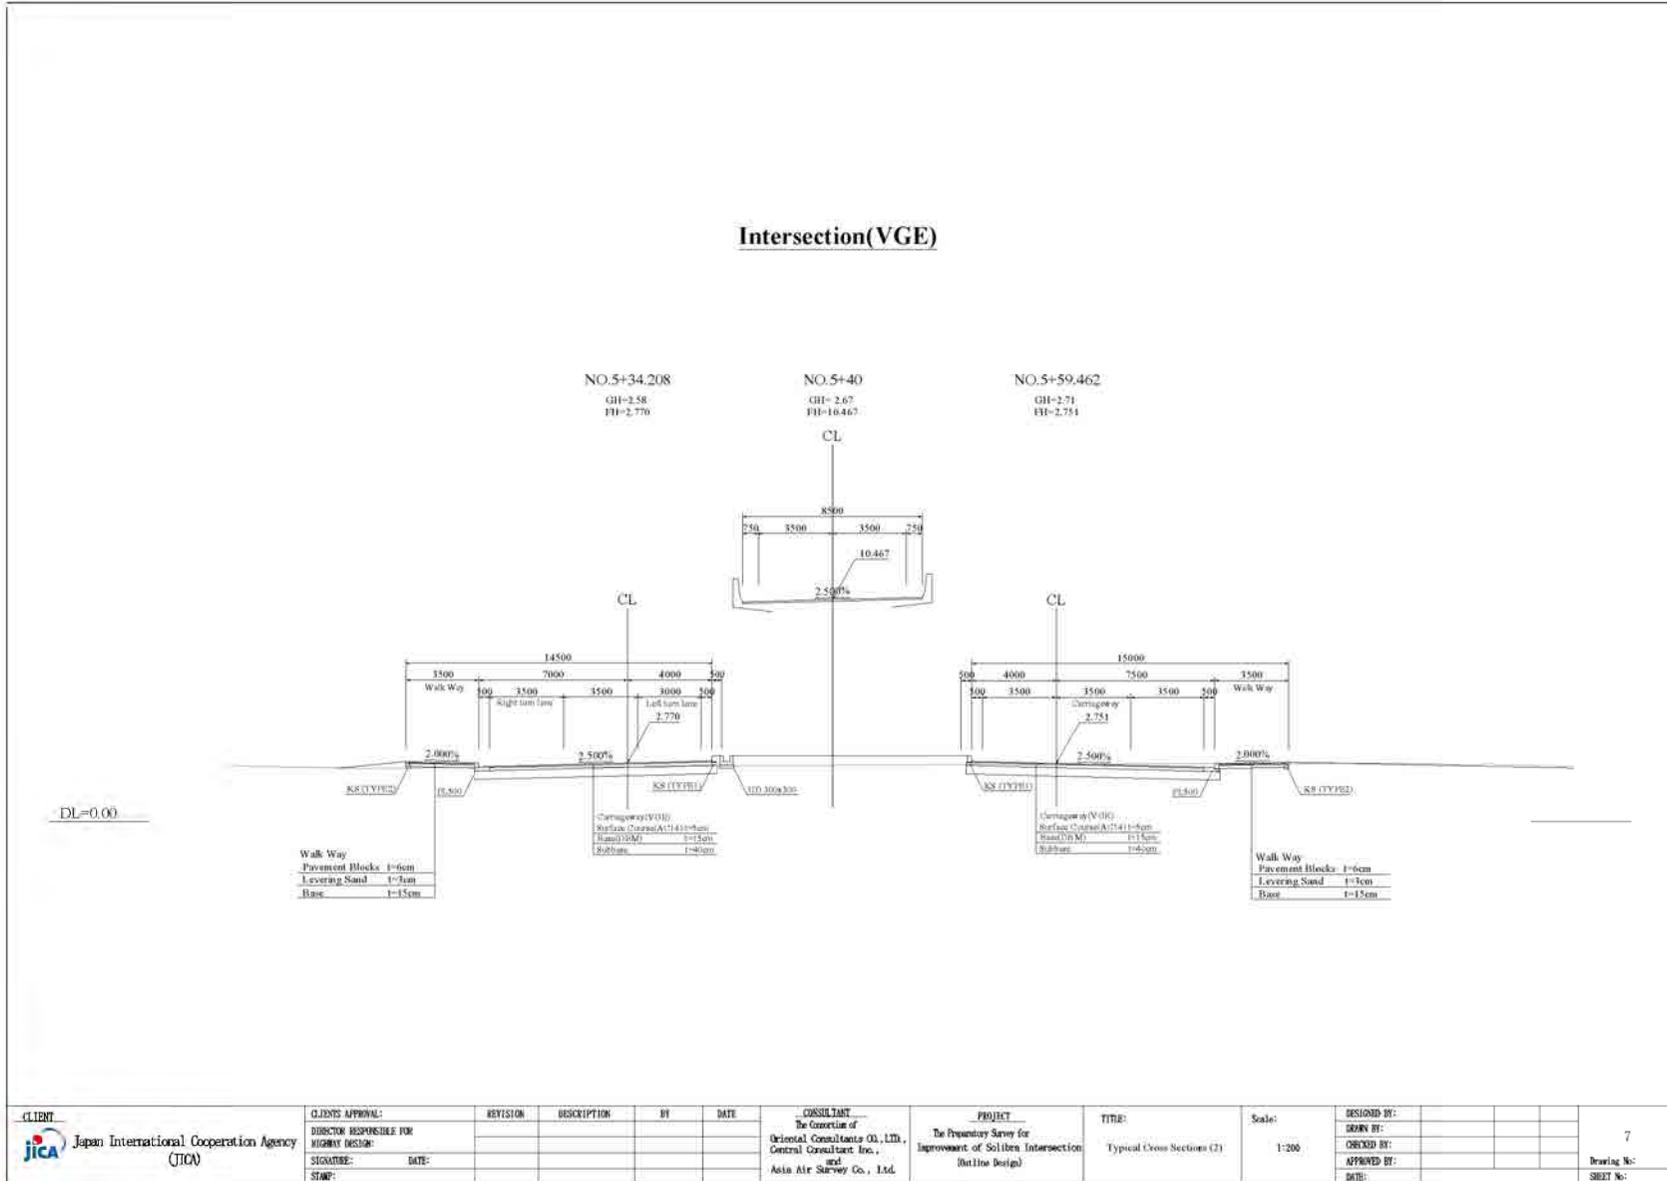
Coupe transversale type (VGE ; carrefour)
